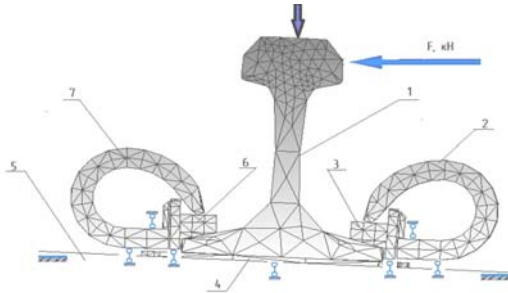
Розрахункова схема вузла рейкового скріплення типу КПП-5:
